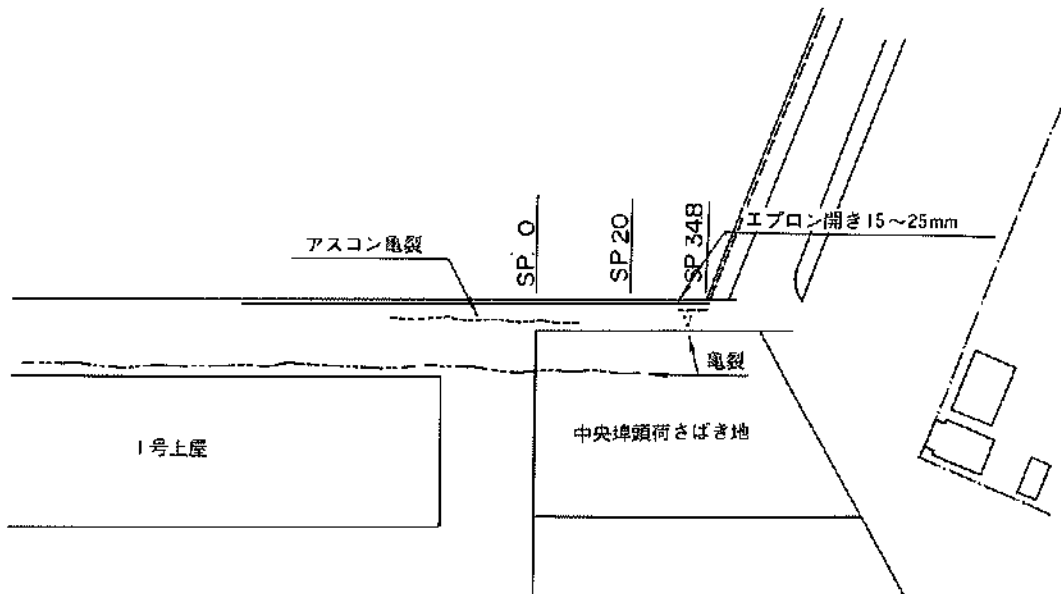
エプロンラック平面図 (中央埠頭地区⑦⑧岸壁(-9.0m))
